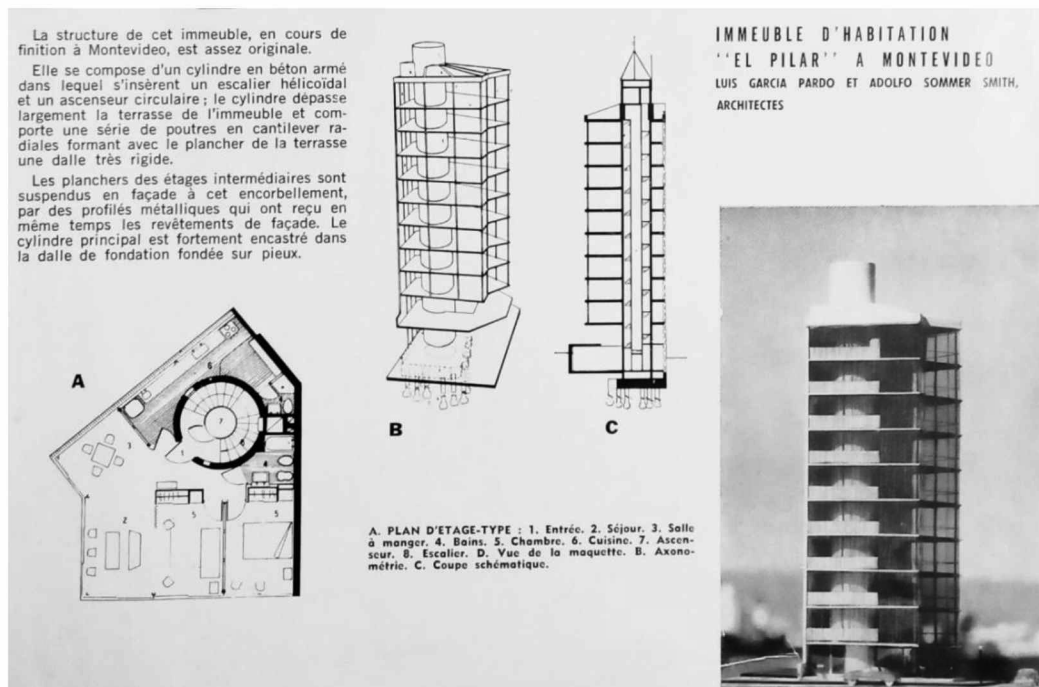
Planta tipo, esquemas estructurales y maqueta del edificio El Pilar.
